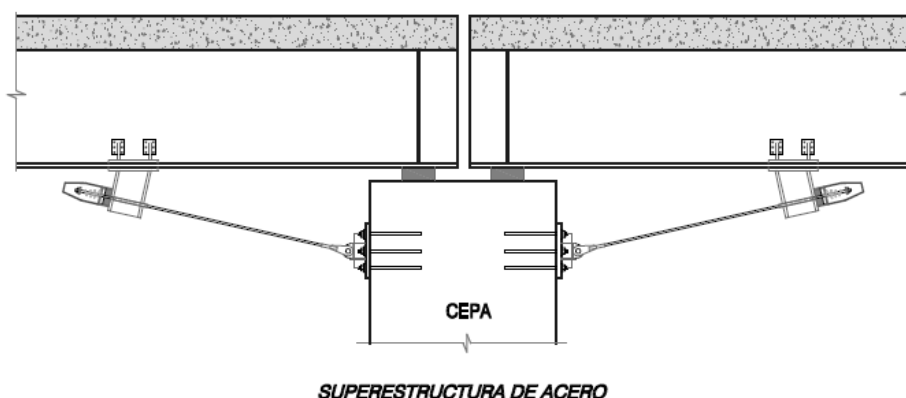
Ejemplo de Sistema de prevención de pérdida de apoyo mediante cables conectando las superestructuras al cabezal de la cepa donde existe una junta de dilatación
